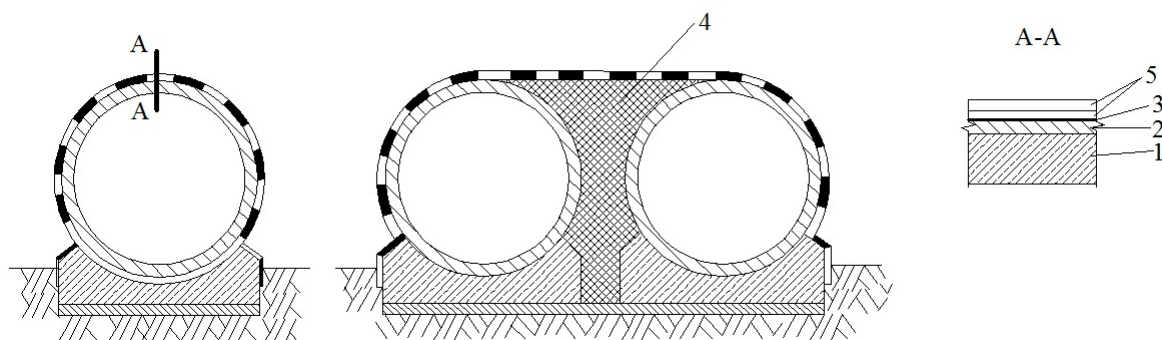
Гидроизоляция сборных железобетонных круглых водопропускных труб типа БМ-3: 1 – звено трубы; 2 – подготовительный слой; 3 – битумная грунтовка; 4 – заполнение; 5 – два слоя битумной мастики толщиной 2,5–3 мм
